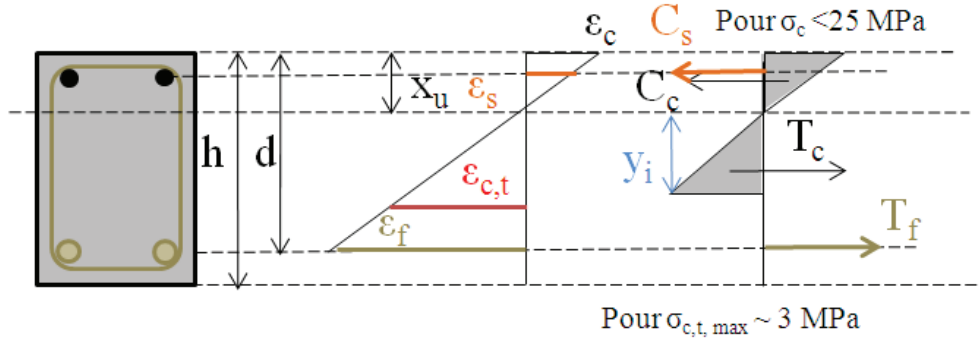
Forces s'exerçant sur la section centrale d'une poutre en phase 2
